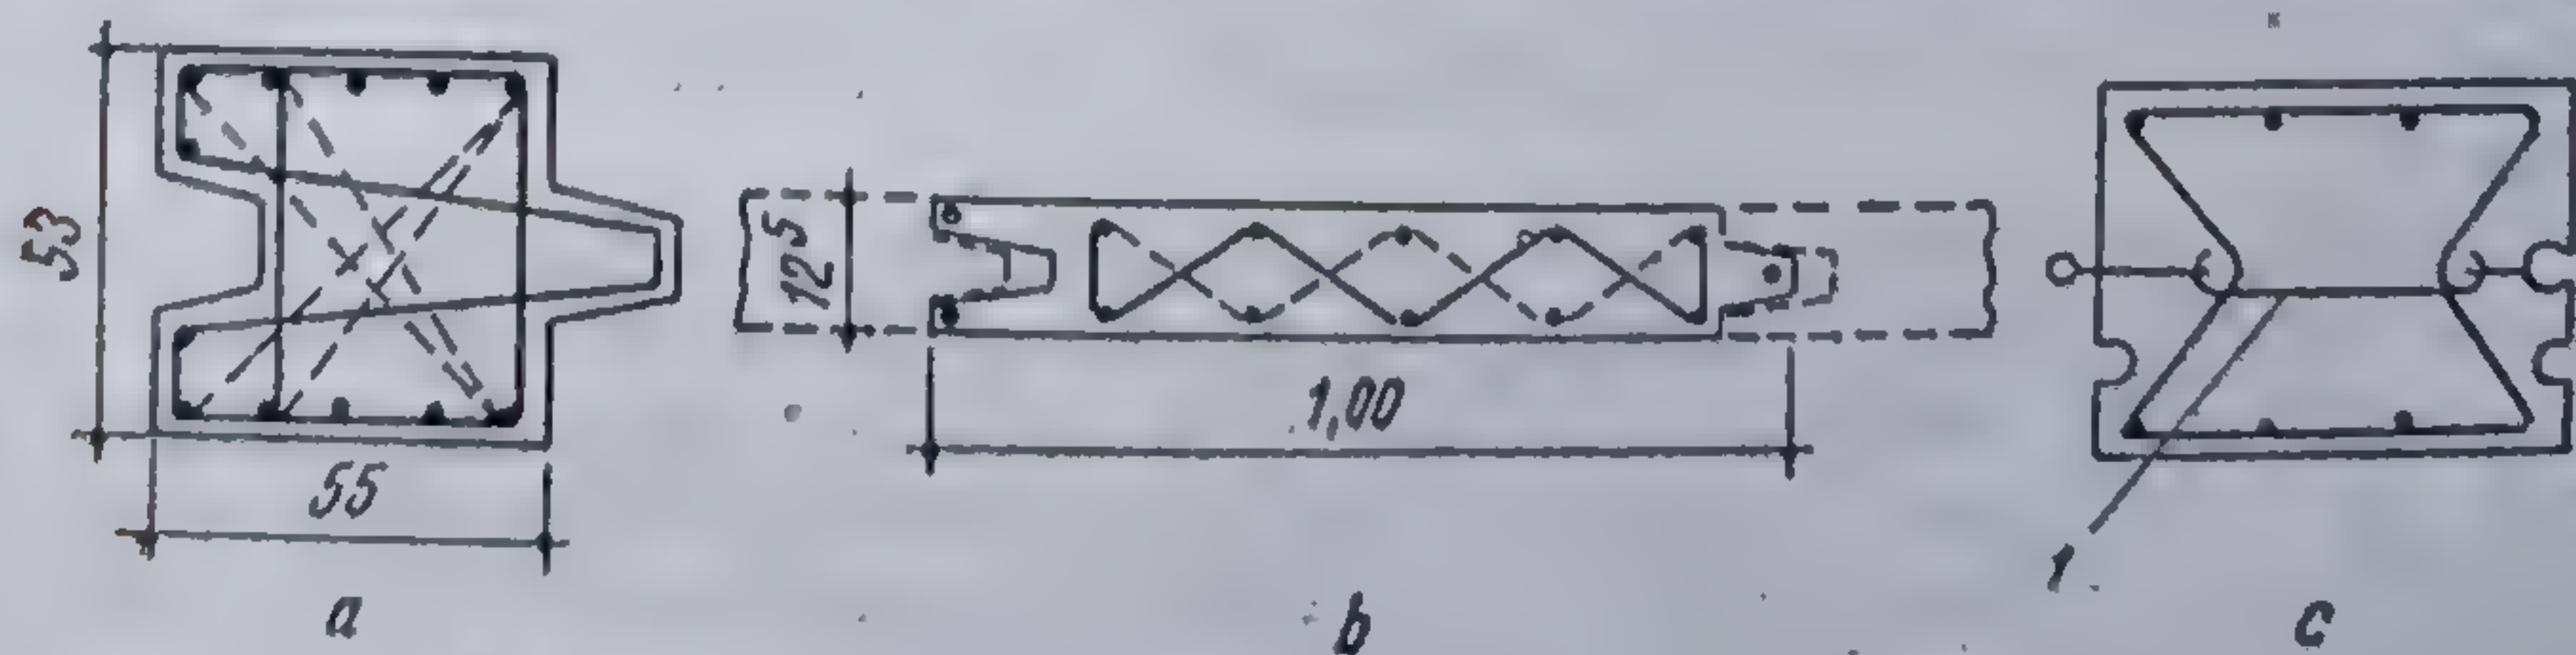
Secțiuni de palplanșe din beton armat:
